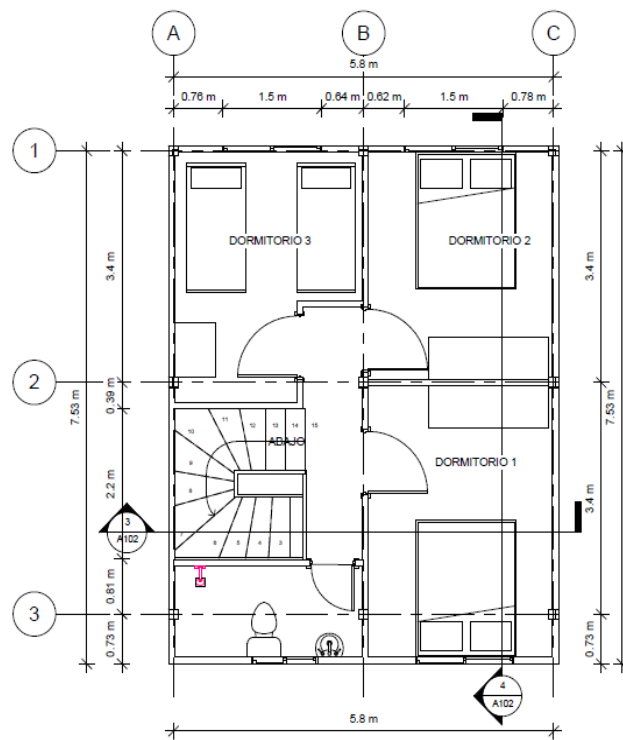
Vista en planta vivienda dos pisos (planta alta)
